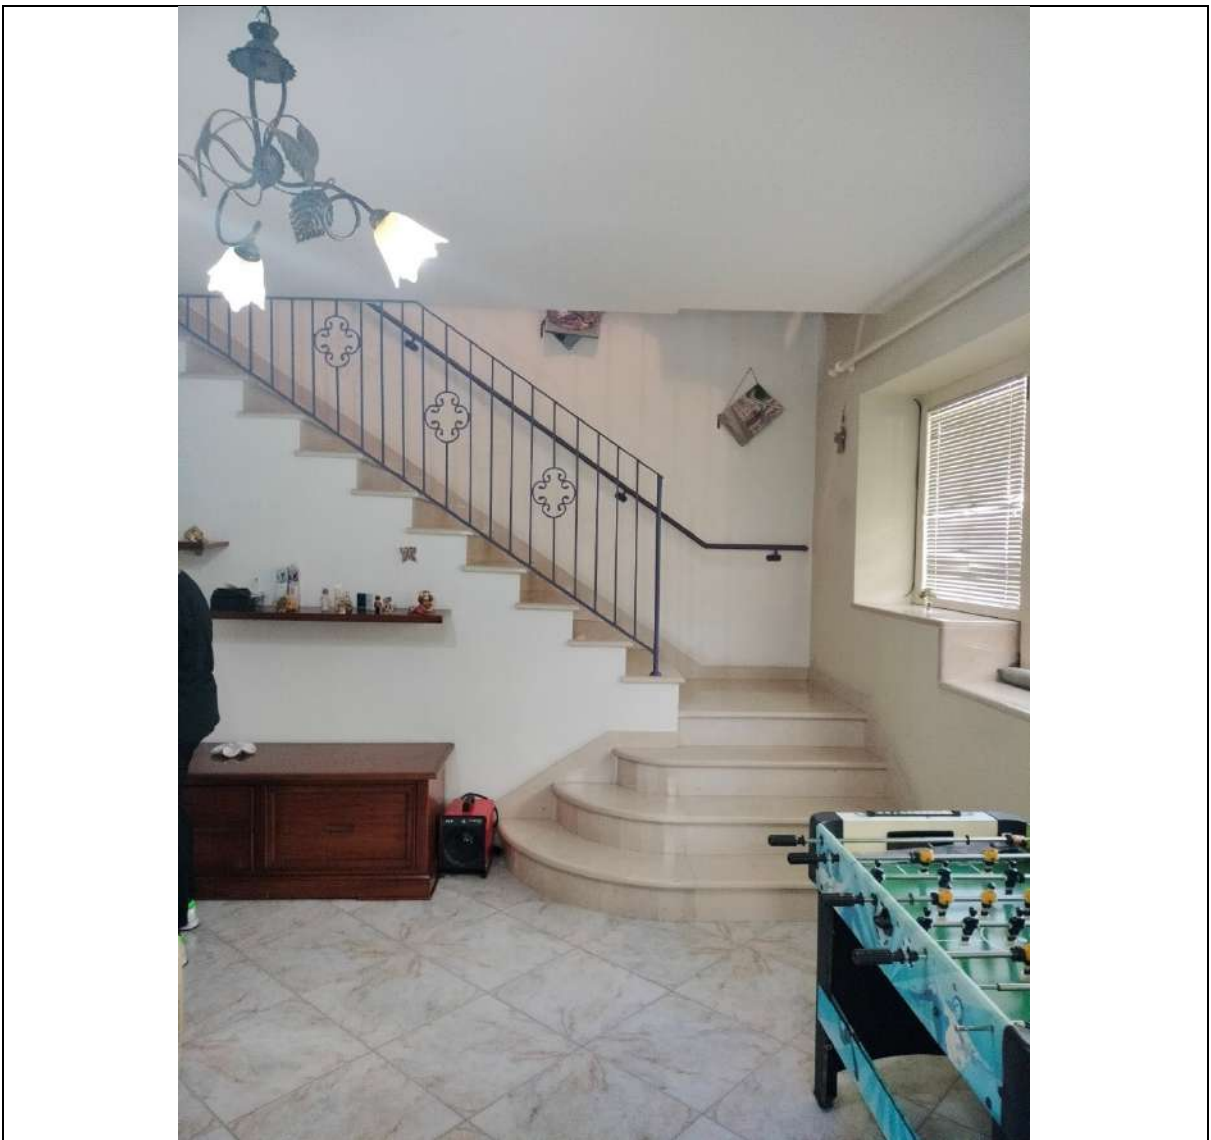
Piano rialzato: vista della scala di collegamento PR-P1
